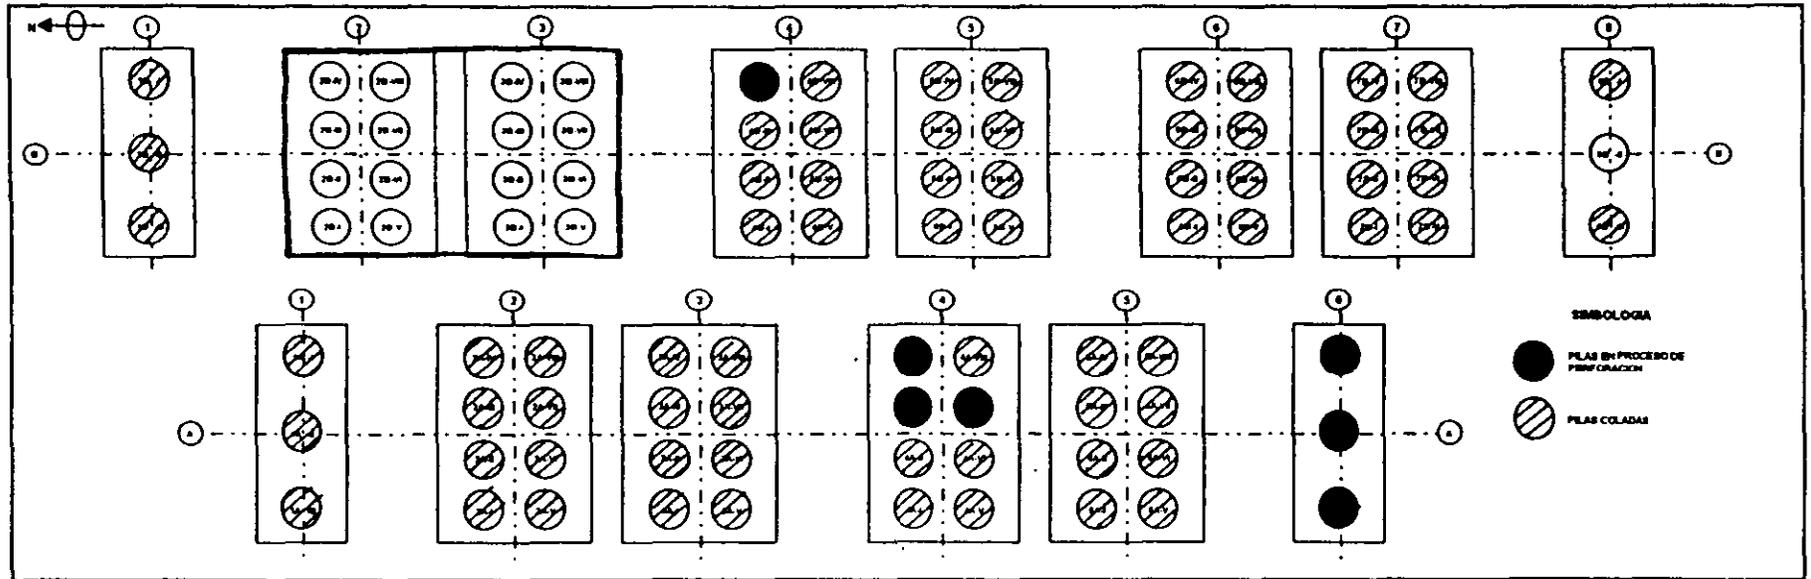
D Arreglo general de las zapatas de cimentación
